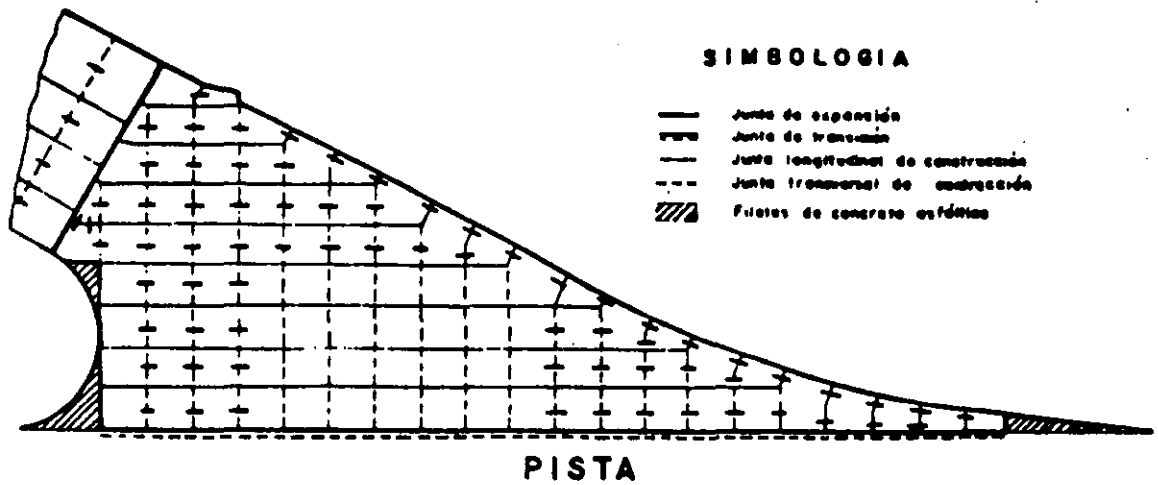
Distribución típica de losas de concreto en entronques entre calles de rodaje de alta velocidad y pistas asfálticas
